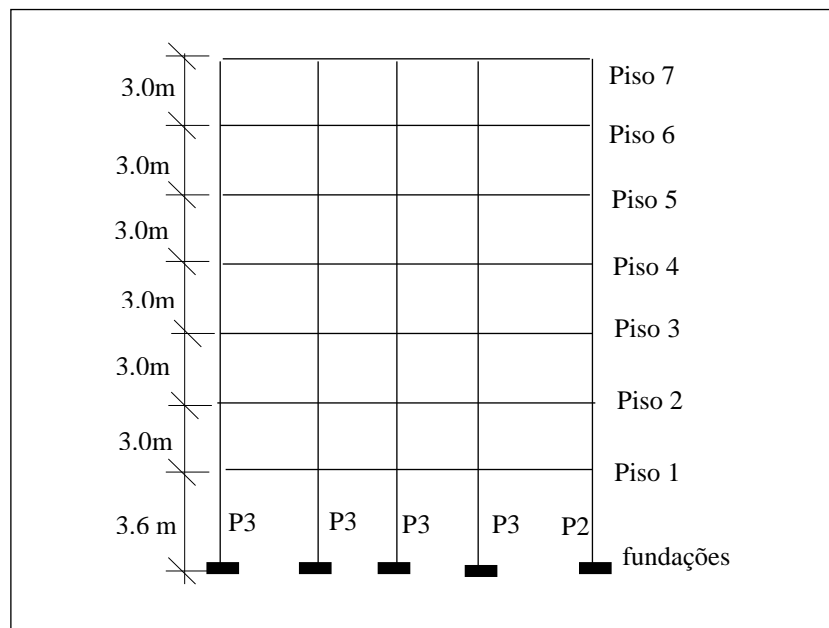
Corte A (assinalado na planta) do edifício existente.
